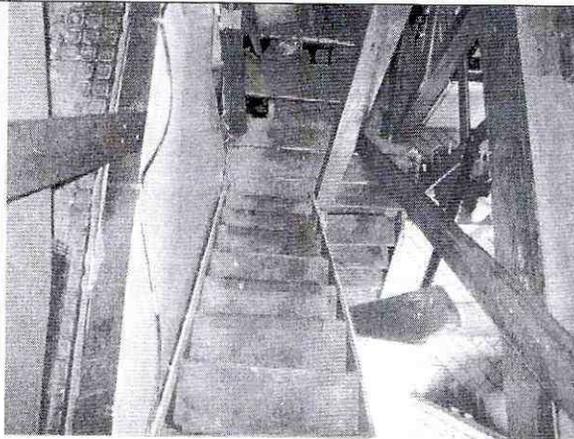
Escaleras en madera estables pero con deterioro incipiente.
